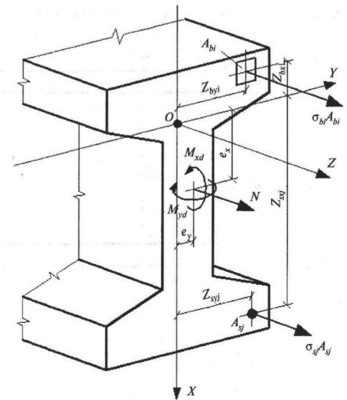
Расчетная схема нормального сечения железобетонного элемента по деформационной модели по СП 52-101-2003
